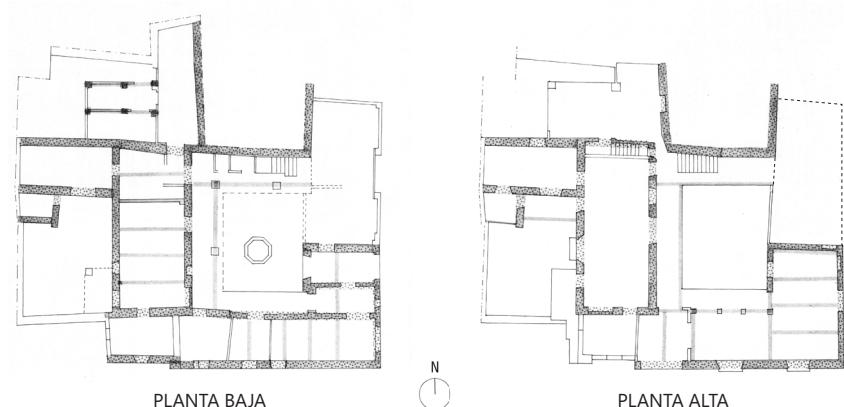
Plantas baja y primera con los elementos portantes previos a la rehabilitación: muros, pilares y vigas. Obsérvese la compartimentación del zaguán y la posición anterior de las escaleras no originales.
